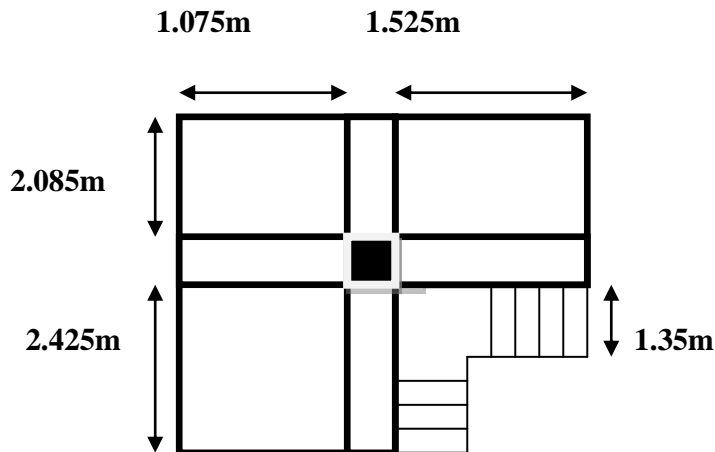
Poteau « P₁ » de la descente de charge.
